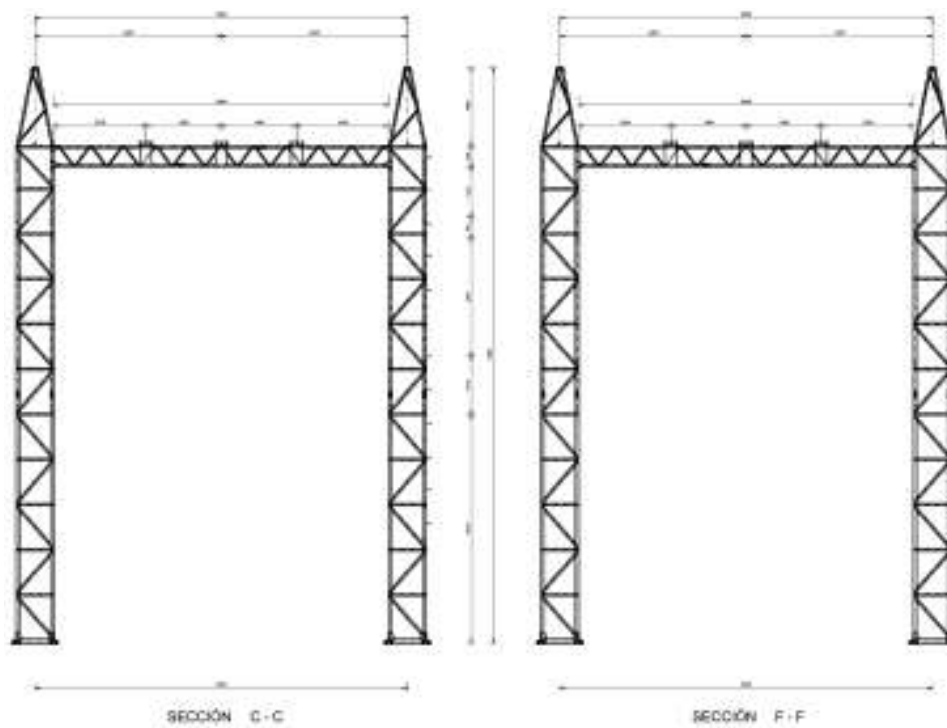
Sección C - C y F - F de la estructura metálica de la barra de 69 kV.
